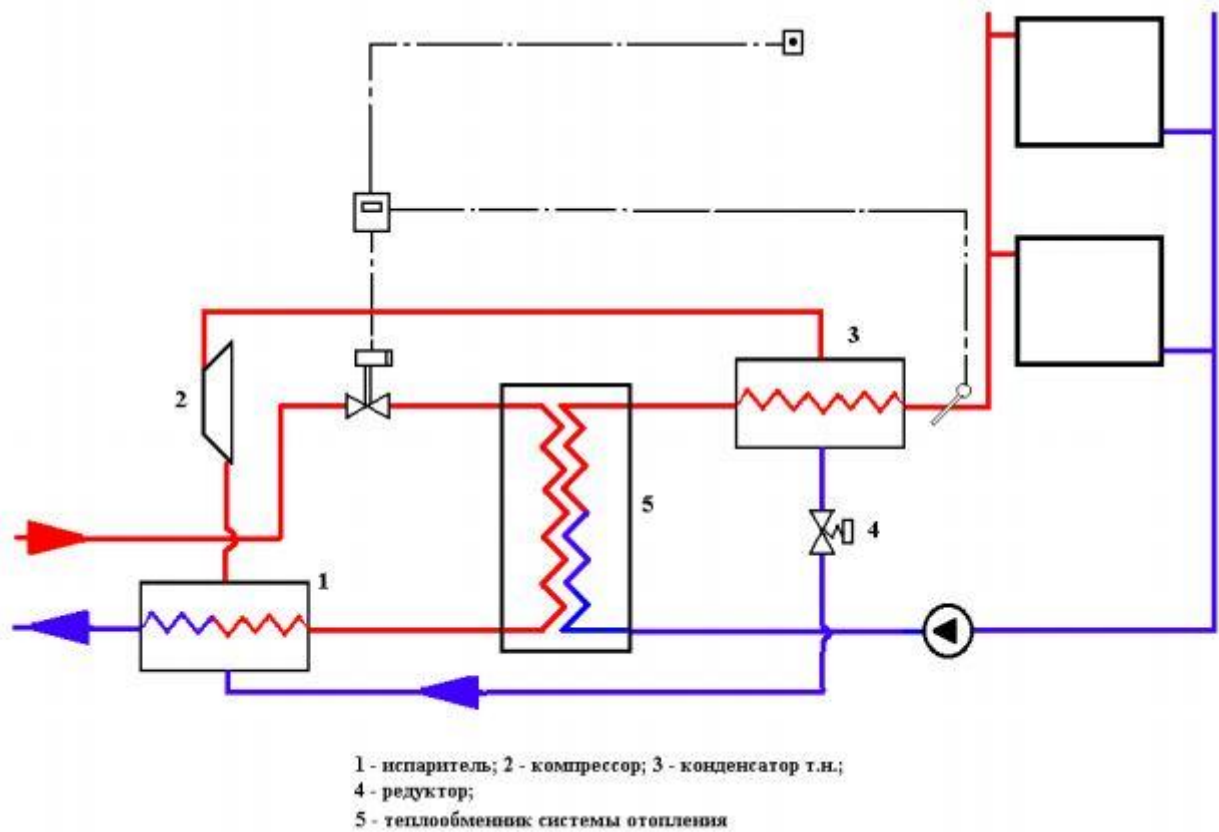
Схема теплового пункта с тепловым насосом с конденсатором на подающем трубопроводе системы отопления
